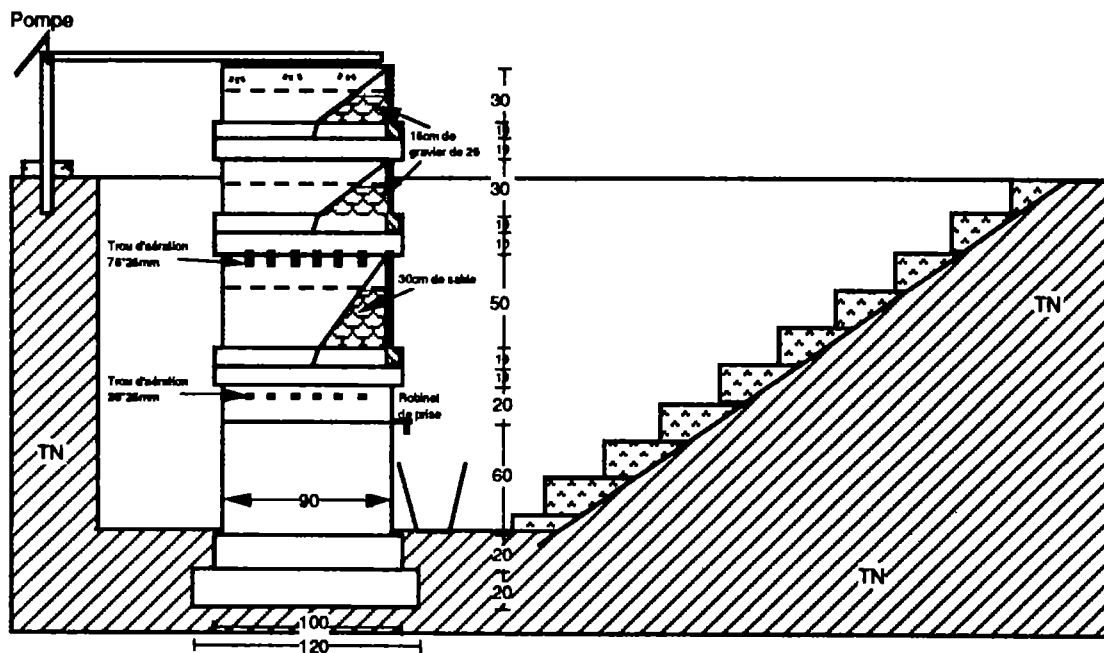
Coupe verticale d'un dispositif de déferrisation type "AF" en béton armé
